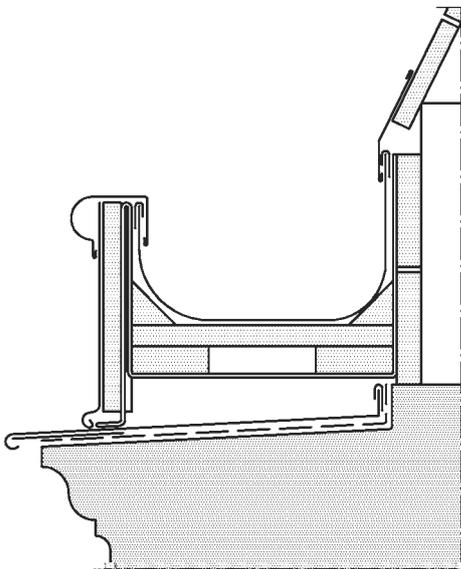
Chéneaux rectangulaires sur entablement ou à l'anglaise
